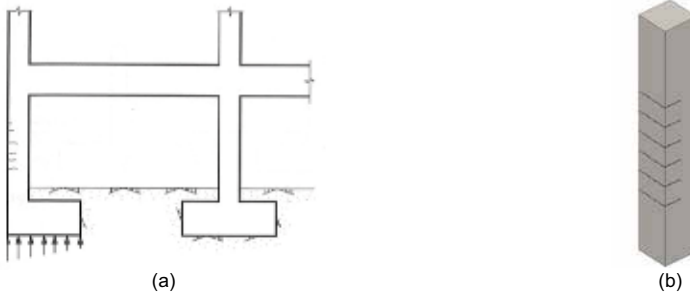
Fisuración en pilares con zapata de medianería o esquina. (Fuente: (a) Calavera, 2005. (b) Serrano, 2013)
